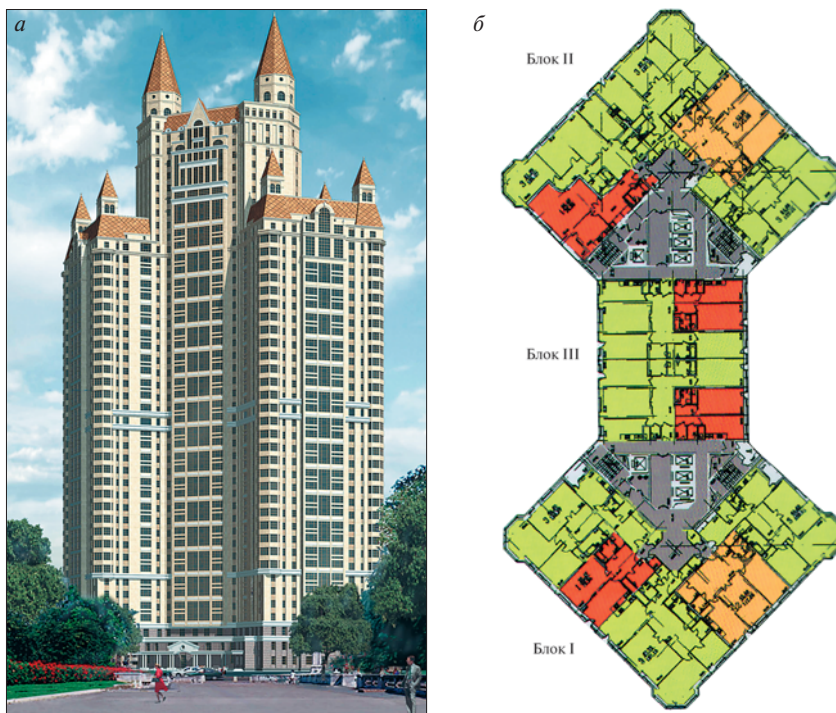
Жилой дом «Эдельвейс»: а – общий вид; б – план первого этажа
